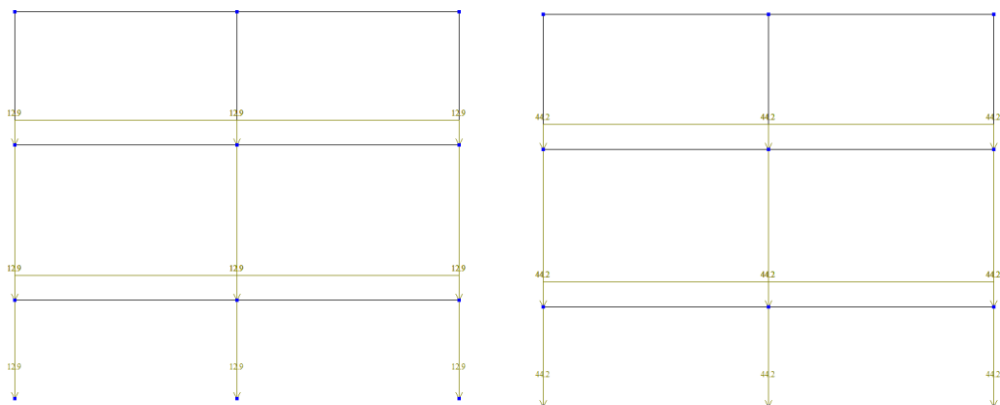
Длительная и кратковременная нагрузка от перекрытий
